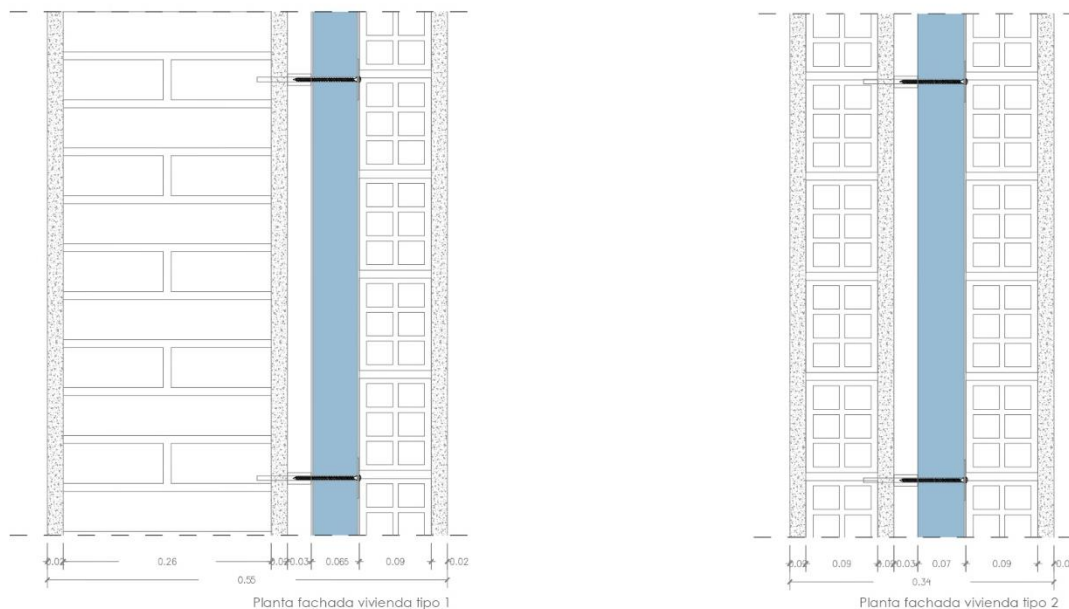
Planta del sistema vivienda tipo 1 y tipo 2 para la ciudad de Santiago. Se adjuntan especificaciones en Anexo (Detalle tipo solución 2, varía el espesor de aislamiento). Fuente: Creación propia.
